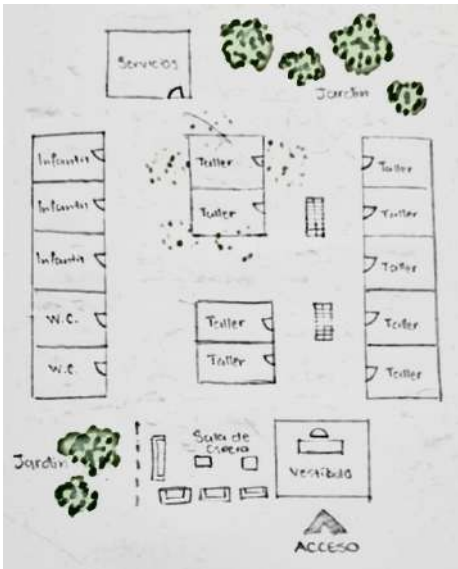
Boceto de planta arquitectónica propuesta 3. Fuente propia.
